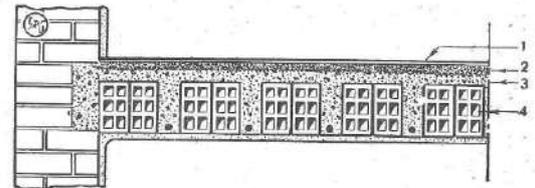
PLANCHER EN BÉTON ARMÉ ET BRIQUES CREUSES COMMUNES - 1 Sol - 2 Sous-couche - 3 Coulage du béton - 4 Briques creuses.
